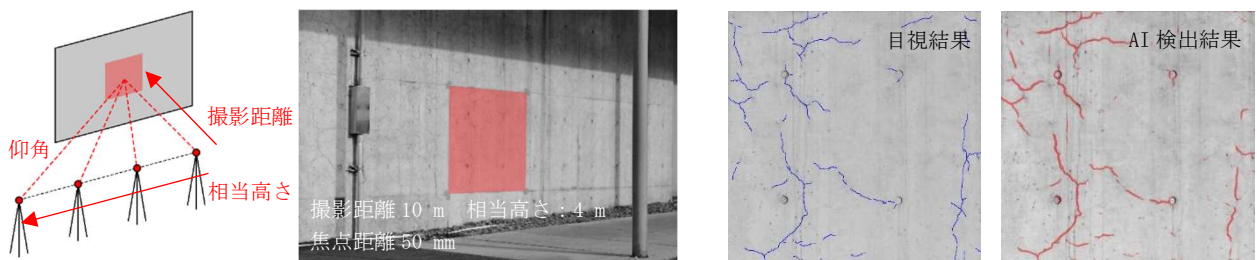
コンクリート打放し仕上げ外壁を対象としたひび割れ検出
